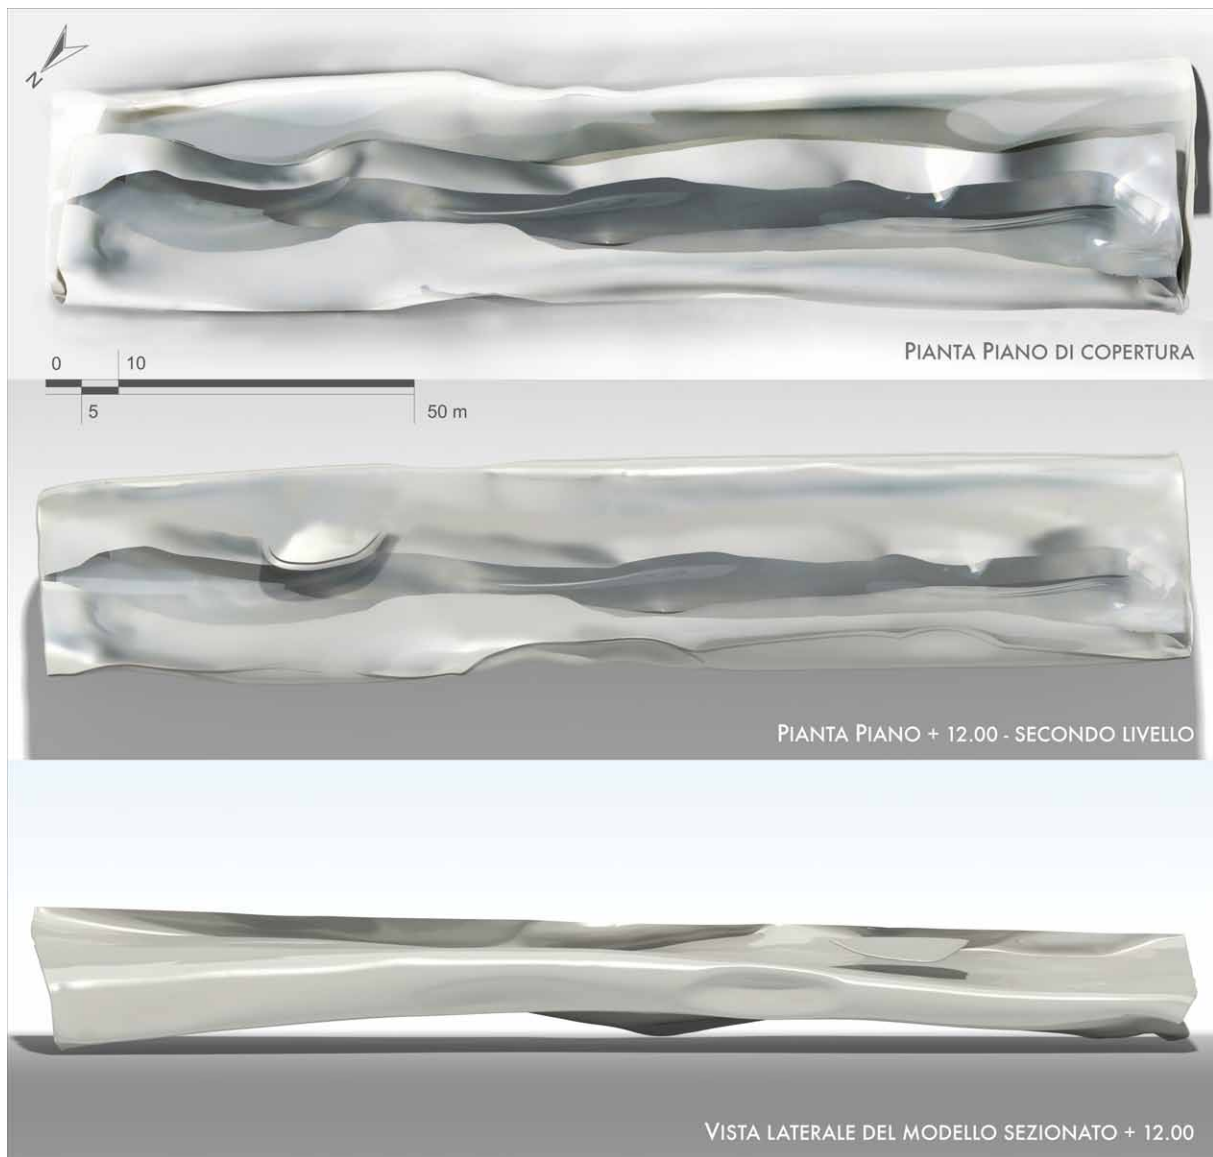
Pianta piano di copertura - pianta piano a quota +12.00 - Vista laterale del modello sezionato
